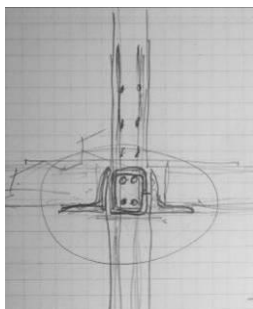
Croquis detalle del encuentro pantalla y steel deck
